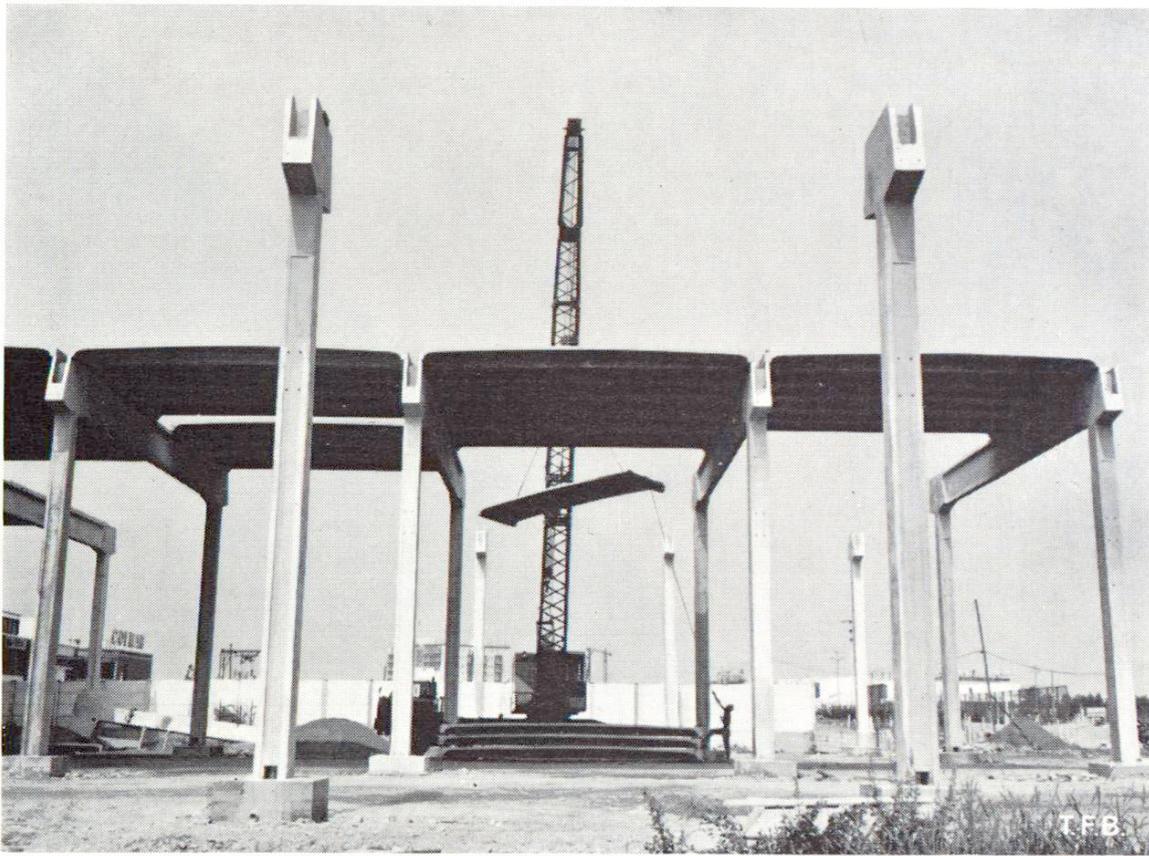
Montage des dalles de la partie médiane du bâtiment. Les eaux du toit sont évacuées par des chéneaux placés sur les poutres.
